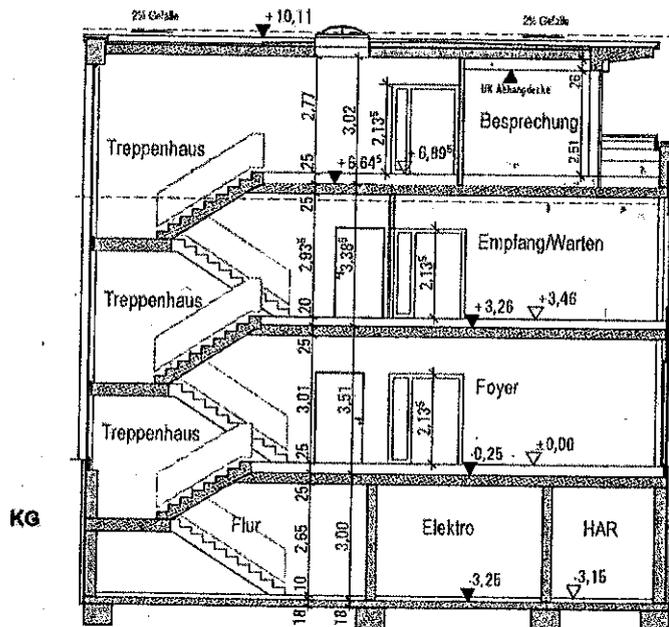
Beispiel 3-geschossiges Bürogebäude
